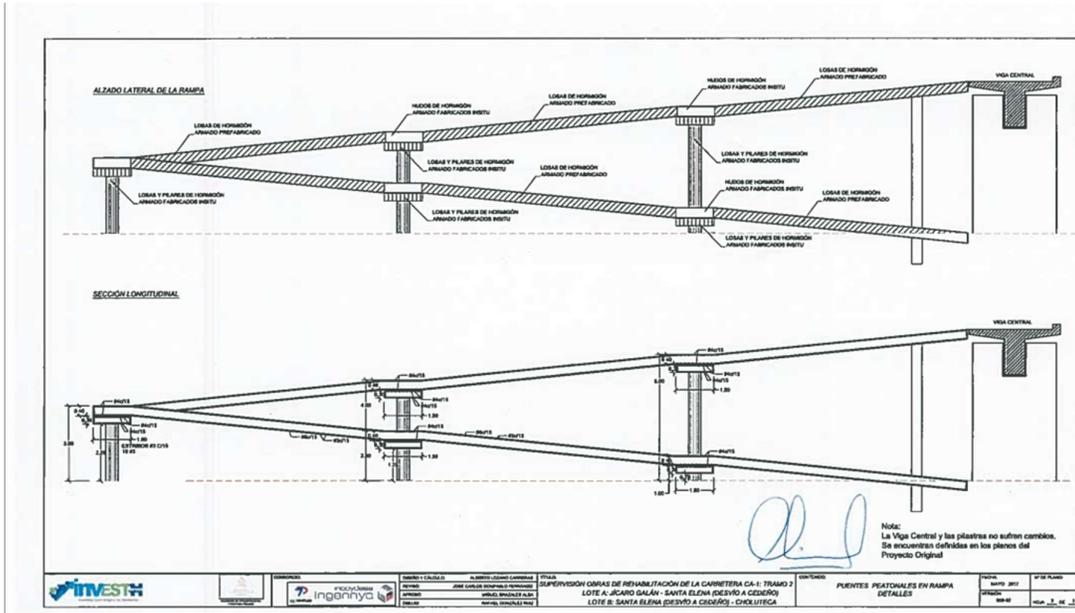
Plano de Perfil del Puente Peatonal con Rampa
